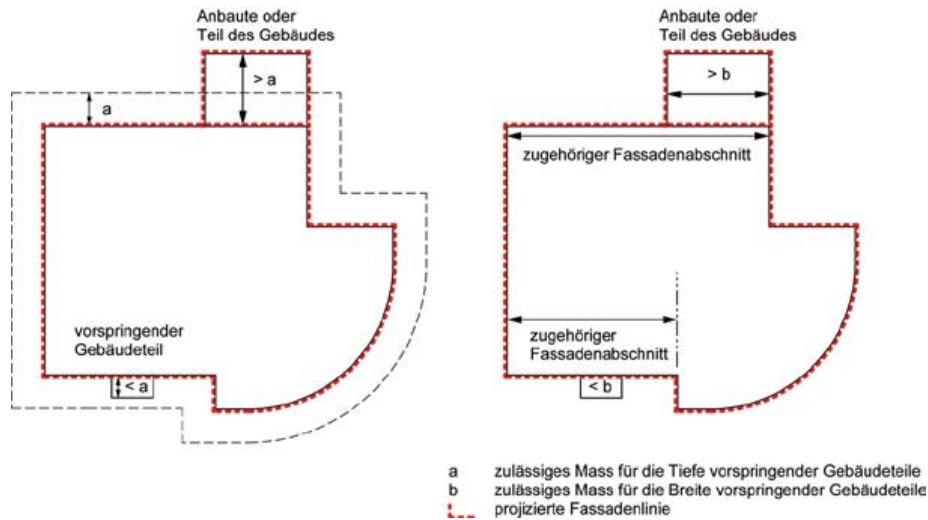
a Fassadenflucht und Fassadenlinie (in ebenem Gelände)
